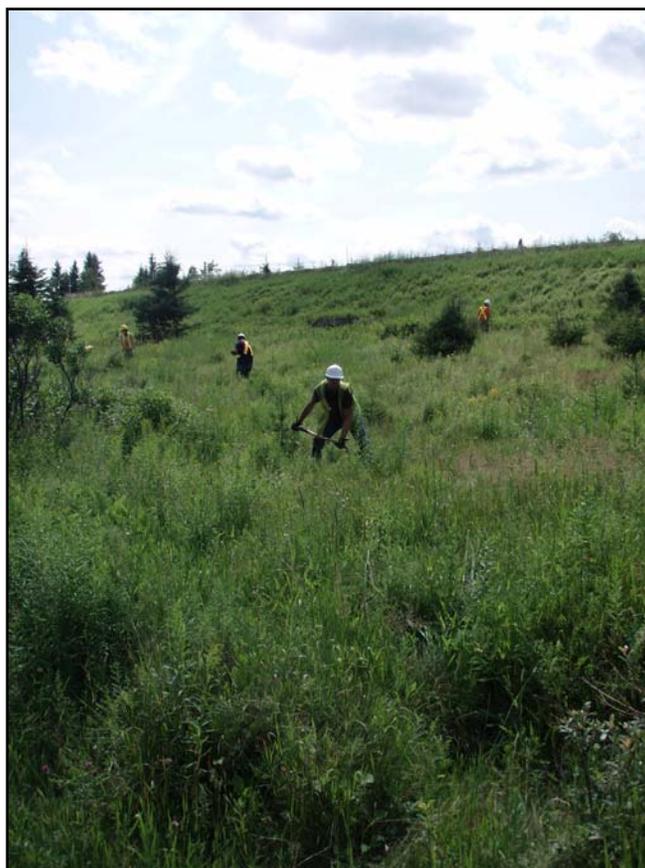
Ruisseau au nord-est de la route 185, secteur 1, sous-secteur 1D, vers 11 + 900, direction sud-ouest (154-02-2012-10-NUM2-78)
